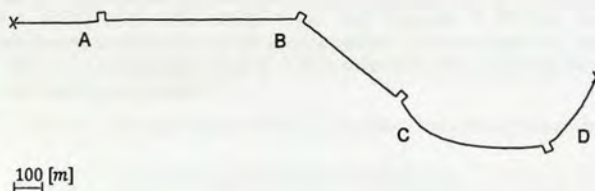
Ubicación de las zonas de desplazamientos relevantes para la cañería con juntas de expansión.
